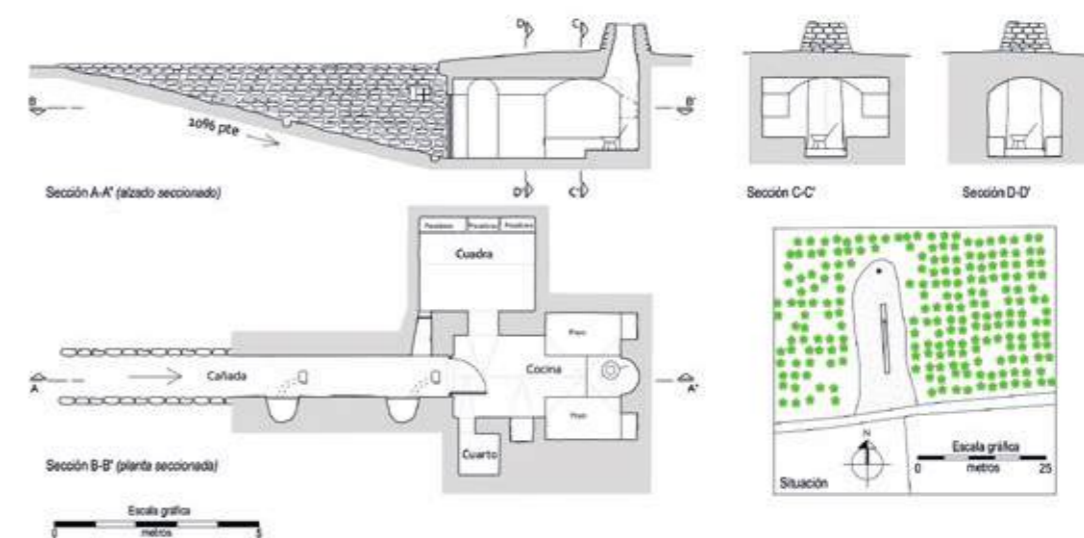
Planta, secciones transversales y longitudinal de la cueva de Casa Quemada II, Daimiel
